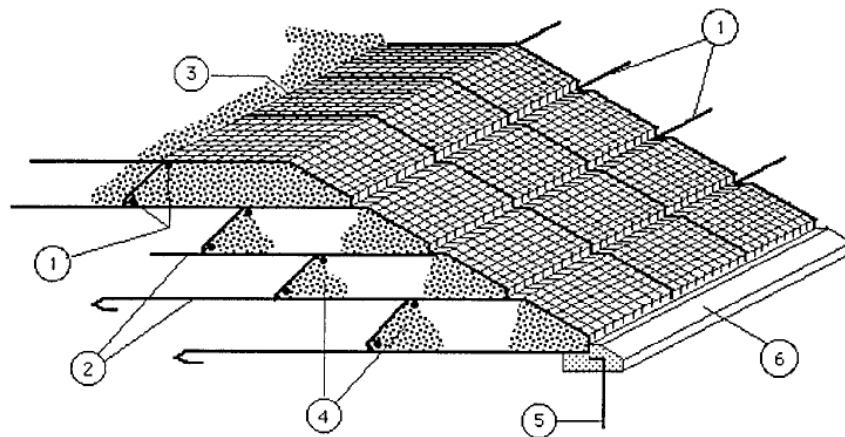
Croquis de una protección de escollera armada. 1: Barras soldadas. 2: Barras de anclaje al cuerpo de presa. 3: Barras transversales paralelas al talud. 4: Mallado superficial. 5: Barras dobladas, tensadas y soldadas. 6: Panel de mallado adicional en cimientos (Fuente: ICOLD 1993).
